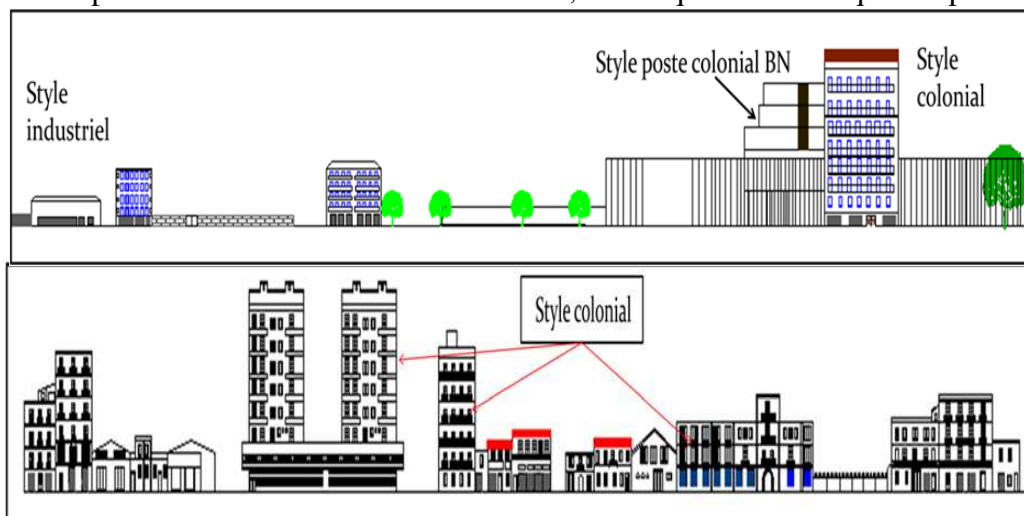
Façade Sud de la rue Mohamed Belouizdad.
